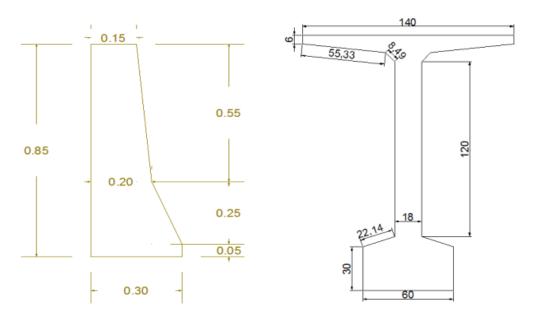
SECCION DE LA DEFENSA Y VIGA
